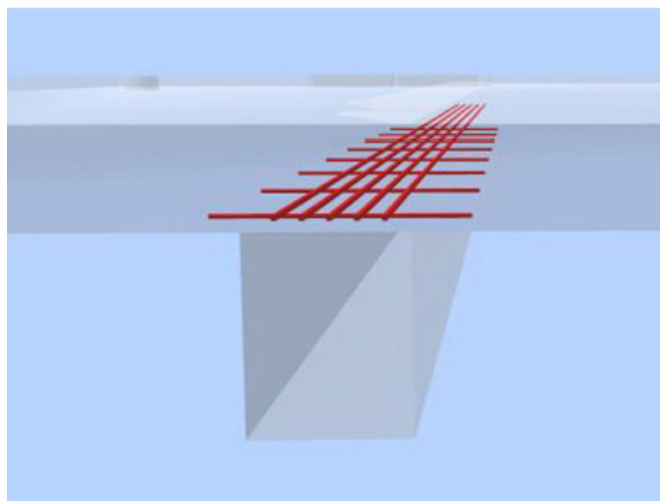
Раскладка нижней и распределительной арматуры балки (ригеля)
